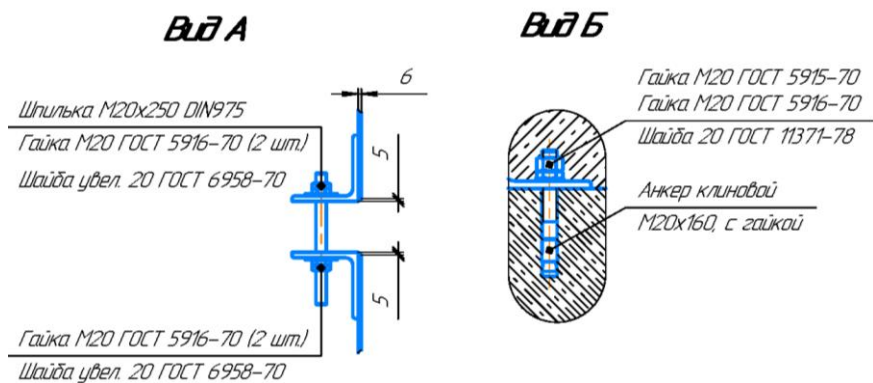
Способ крепления горизонтального корпуса удерживающими лентами производства ООО «АКО»
